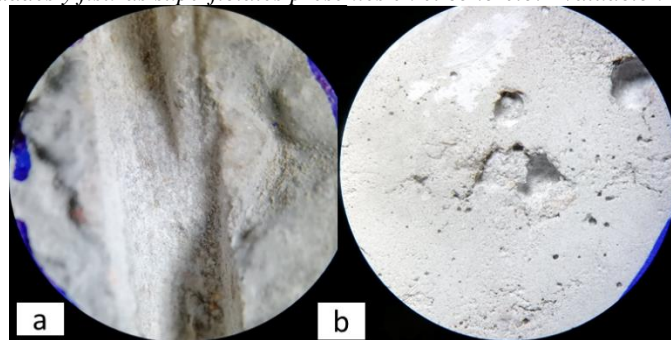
Probeta Piedra 4 2b con 2 ml de Aditivo Bacteriano. (a) vista interna de la fisura inducida (b) vista de discontinuidades y fisuras superficiales presentes en el concreto. Evaluación a los 28 días.
